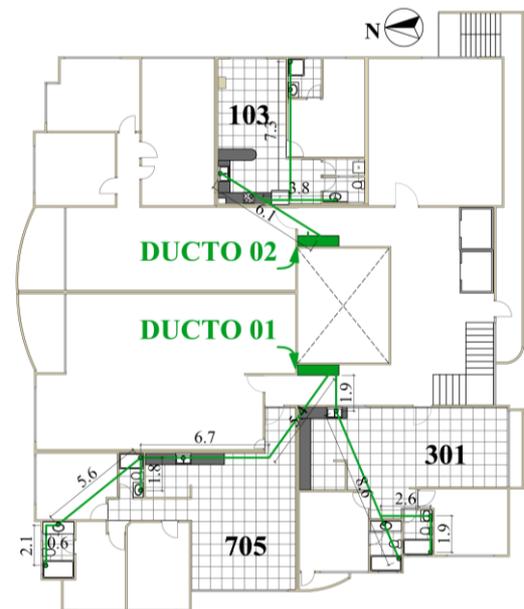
Planta arquitectónica del recorrido de las tuberías a cada departamento
